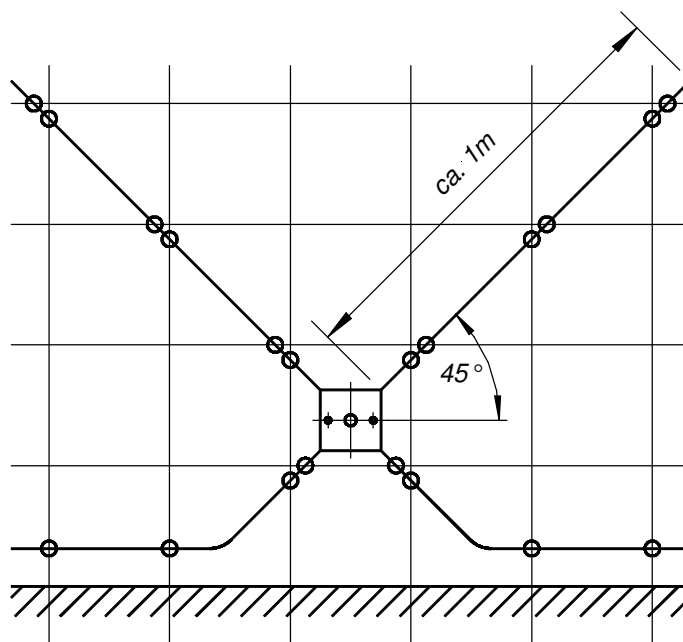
Punto di connessione ZS per il collegamento equipotenziale di protezione a una distanza massima di 1,0 m
